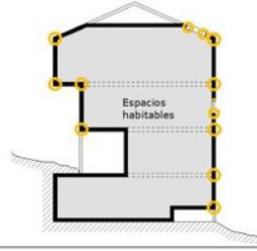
Análisis Pilar en Esquina. Muro de Fachada Norte. CE3X.
